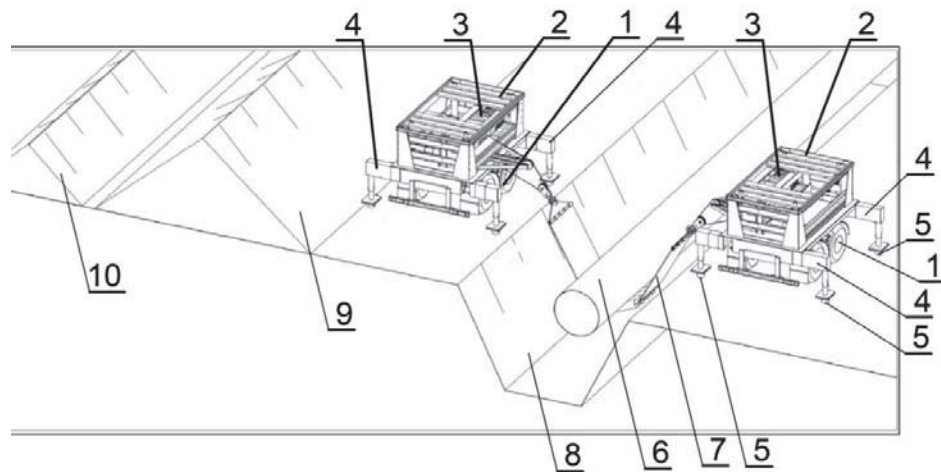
Устройства для монтажа трубопровода без использования стрелового крана [106].
